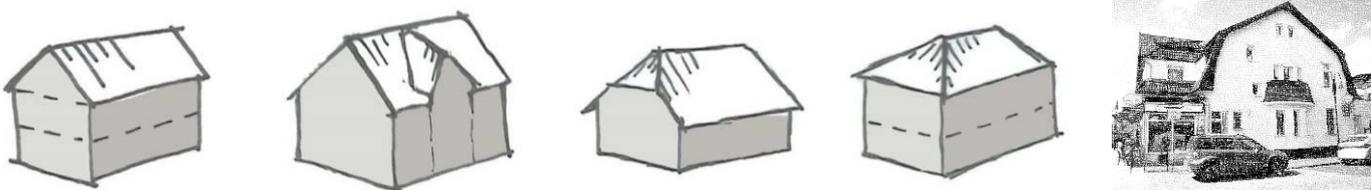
Dachformen (Satteldach, Satteldach mit Zwerchhaus, Krüppelwalmdach, Walmdach, Mansarddach)
